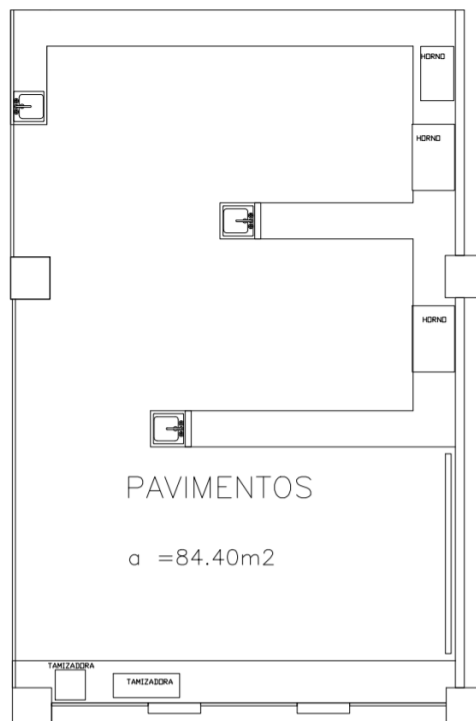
Área de Pavimentos/ Edificio Antiguo
